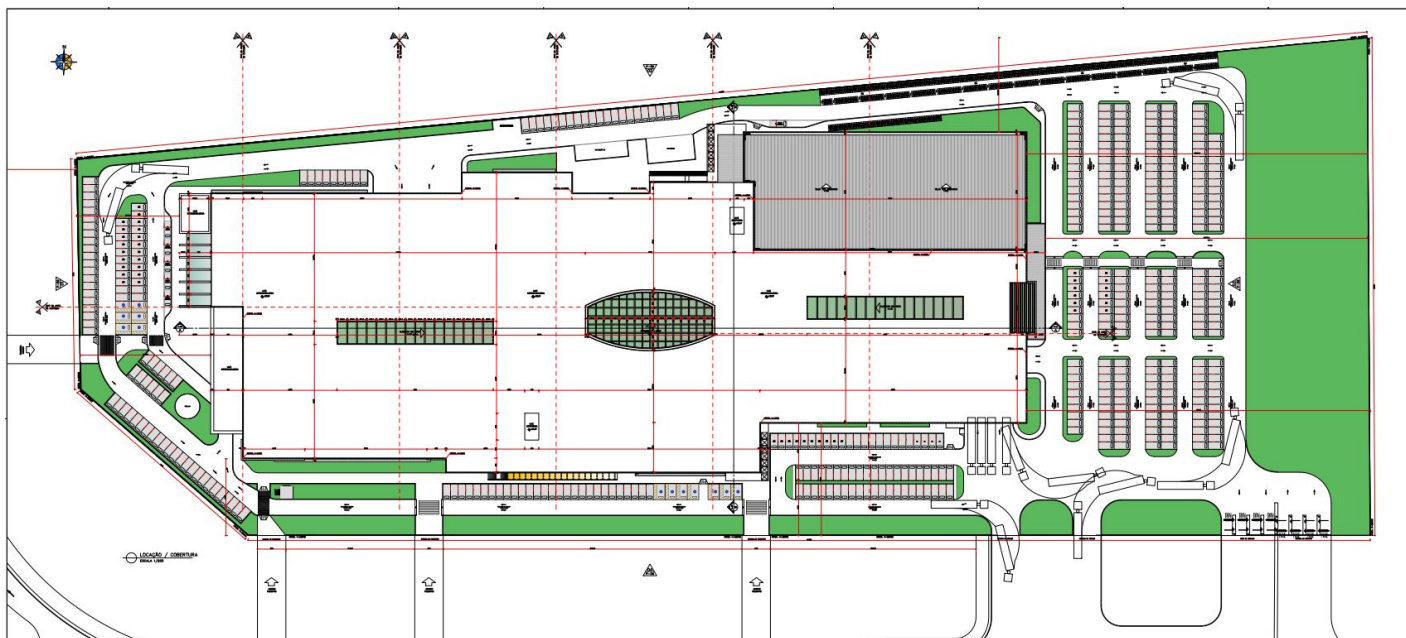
Acessos ao empreendimento. Fonte: Planta de Locação (44701287).
